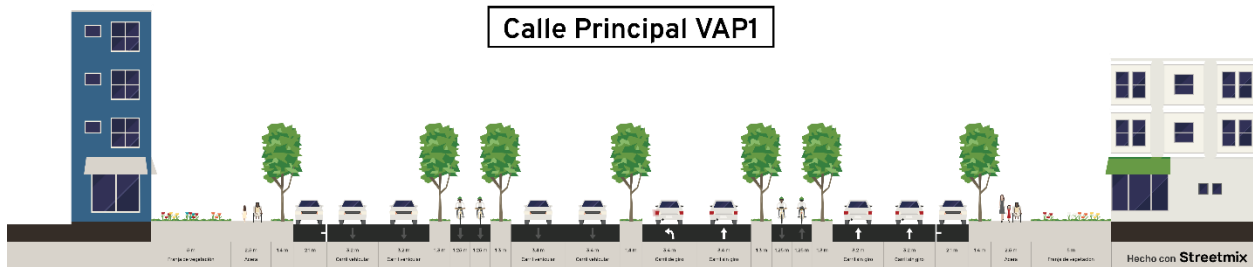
Perfil mínimo Vía Arteria Principal. Fuente: Elaboración propia.
